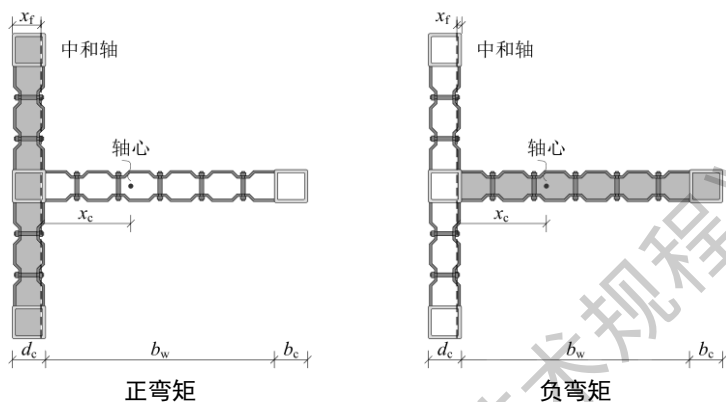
T 形平面布置波形钢板混凝土组合墙中和轴位置
